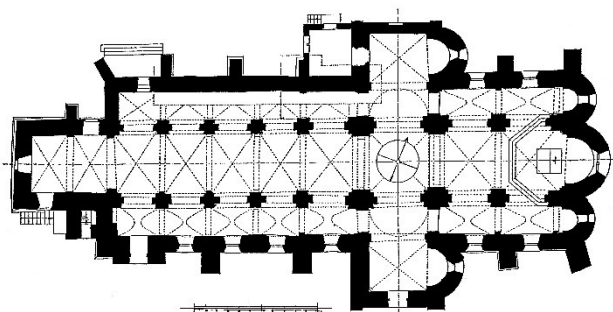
Grundriss der Ulrichskirche Sangerhausen
